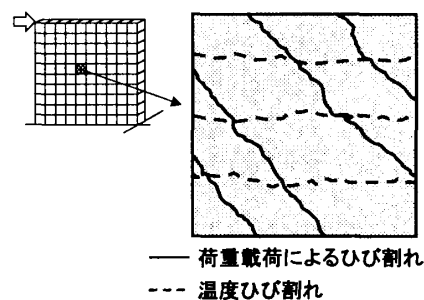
温度ひび割れと荷重載荷によるひび割れ発生状況の模式図
